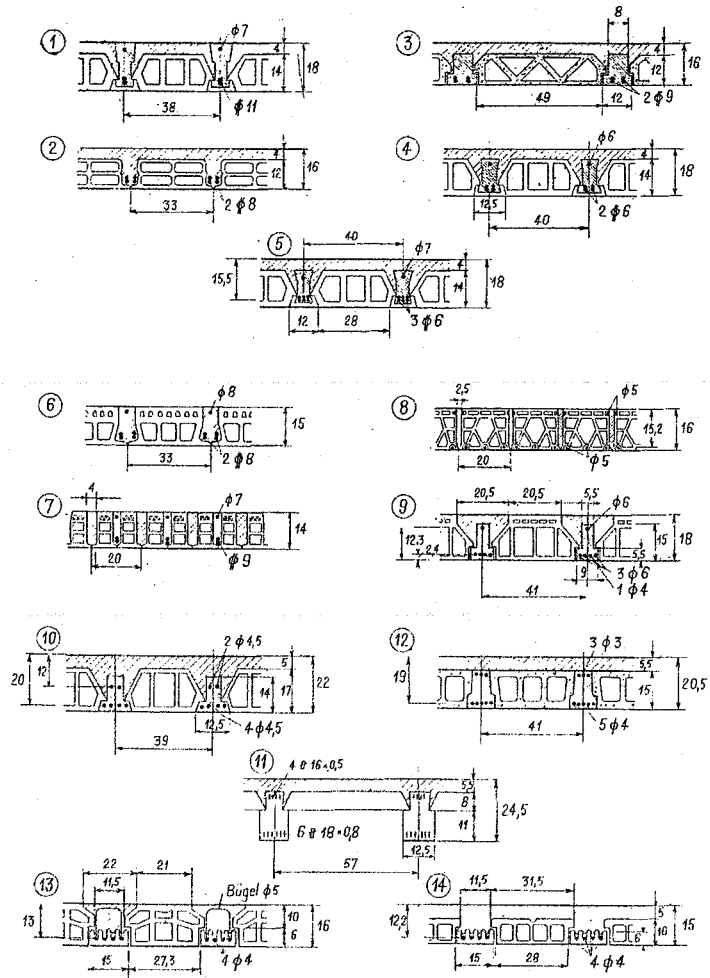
Bewehrung: hochwertiger z. T. kaltgereckter Stahl, Nr. 11 mit Bandstahl. Alle Decken mit Ausnahme von Nr. 2 und 6 sind Fertigbalkendecken. Nr. 1 bis 5, 10, 11, 12 und 14 haben einen Betondruckgurt, die andern einen Gemischtdruckgurt. Nr. 10 bis 14 besitzen vorgespannte Balken oder Bretter.
